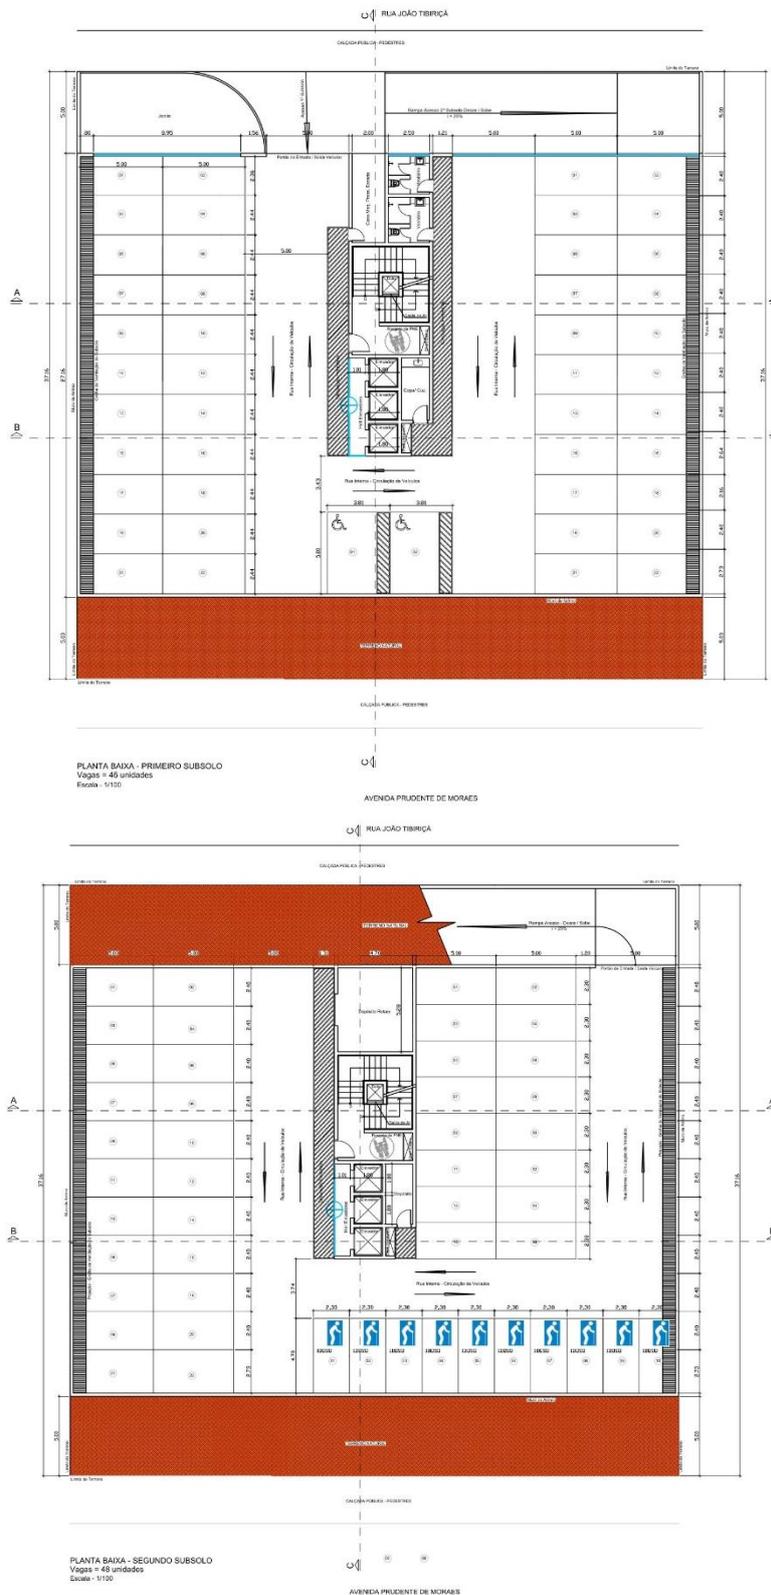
Projeto de implantação do empreendimento: pavimentos subsolo 1 e 2 (garagens).
